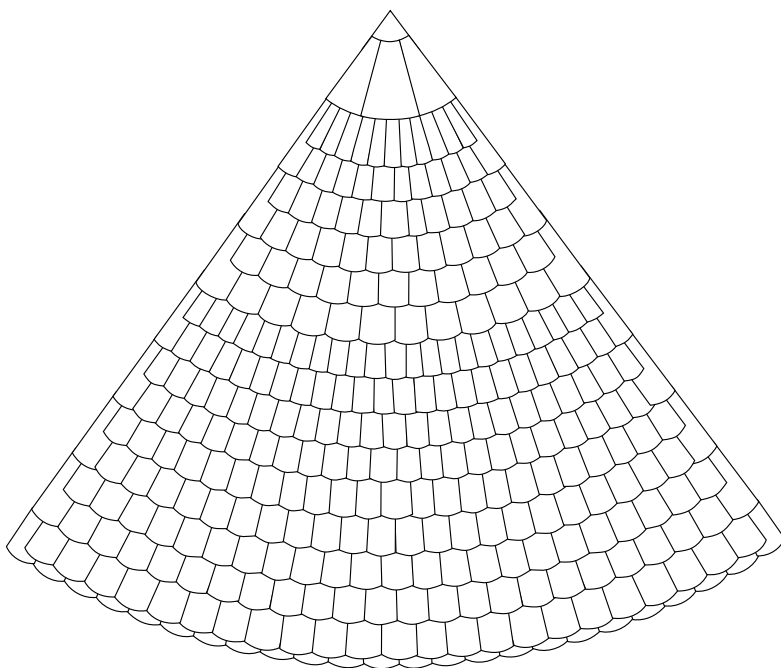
Nanoszenie powierzchni dachu do wyznaczenia wykroju stożkowego przy 60° nachylenia dachu
